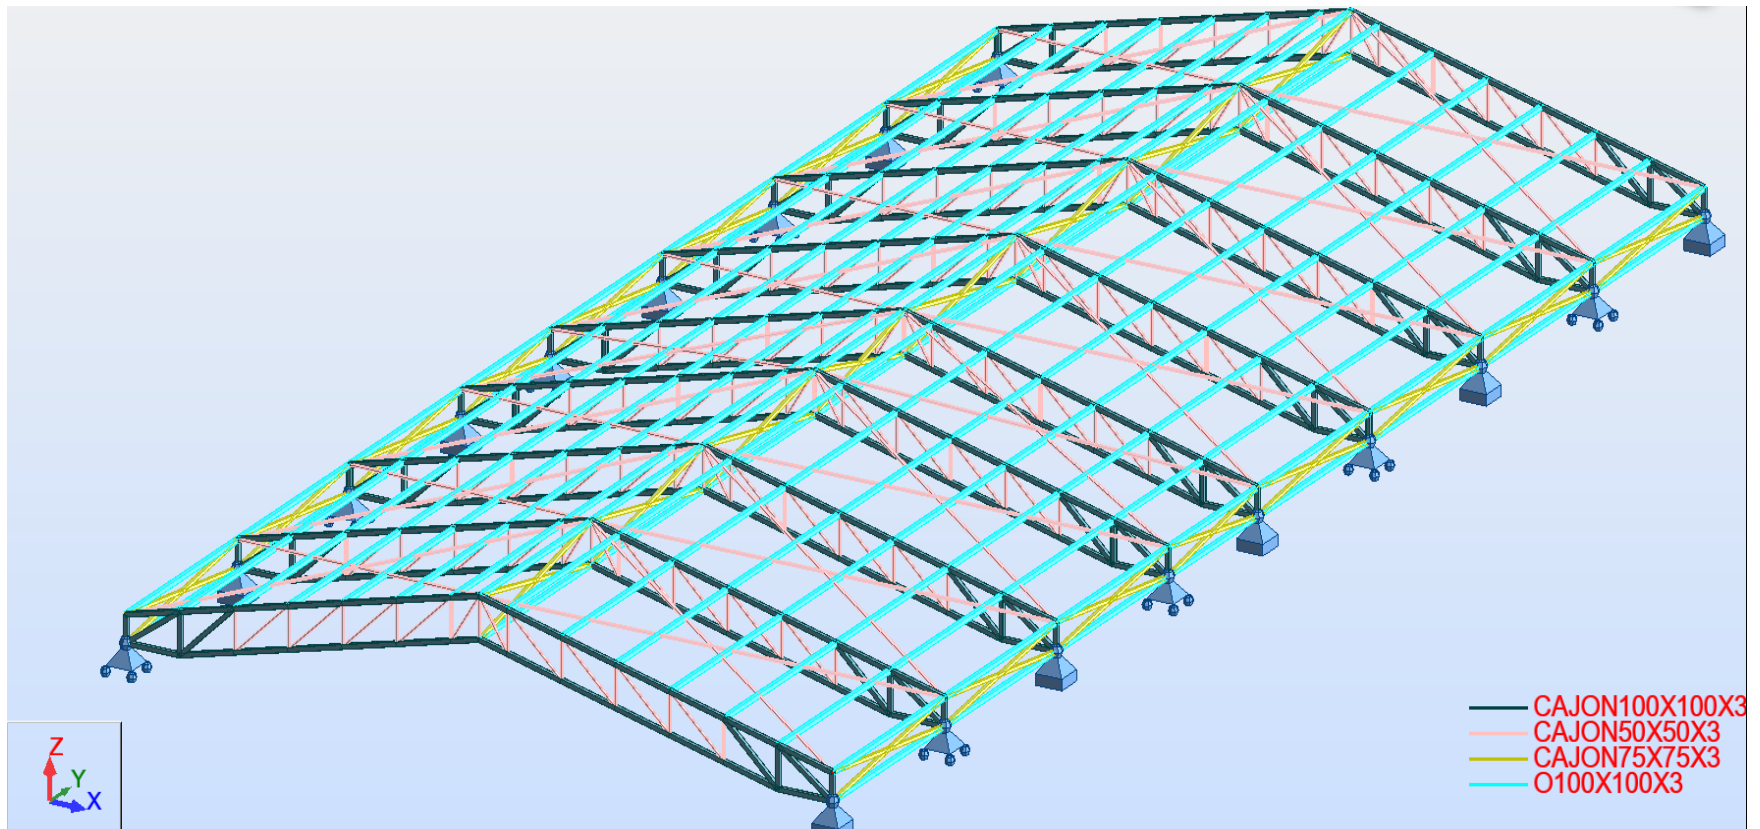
Cubierta Metálica de la Planta General – Modelo independiente
